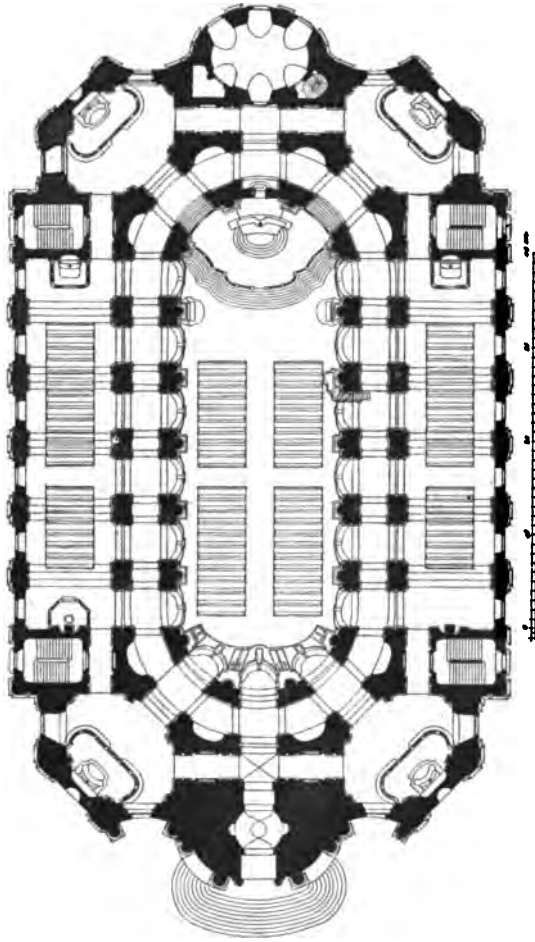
Grundriss der Hofkirche in Dresden (n. Stöckhardt).
